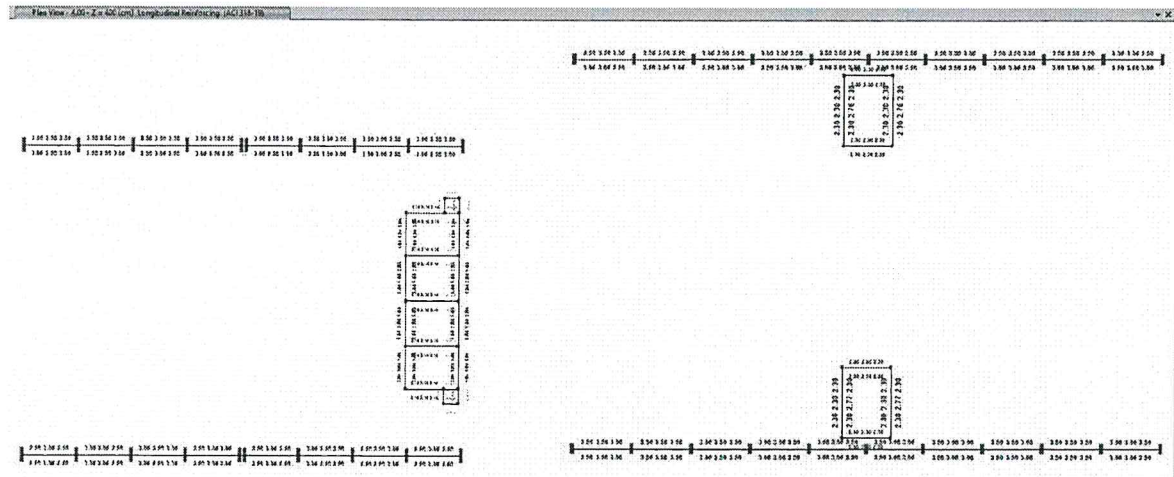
Vista en Planta - Edificación 19-20 - Diseño de Refuerzo Longitudinal y Transversal en las losas, calculando el Área (As) en cm²; Calculado por el Programa ETABS Ultimate C 19.0.0.
